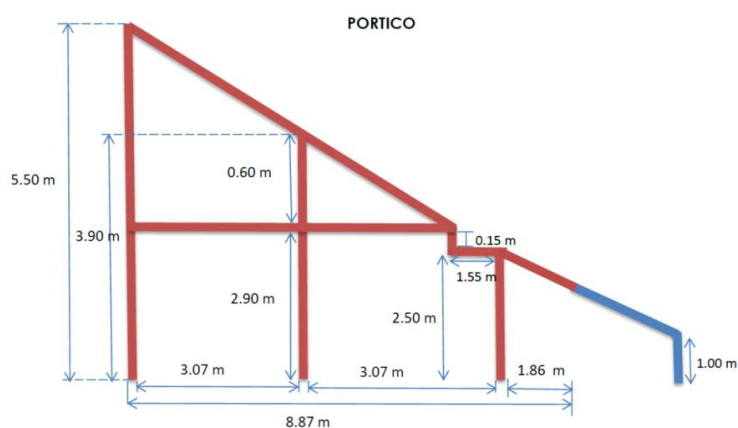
Distribución columnas y vigas pórticos Módulo Q
